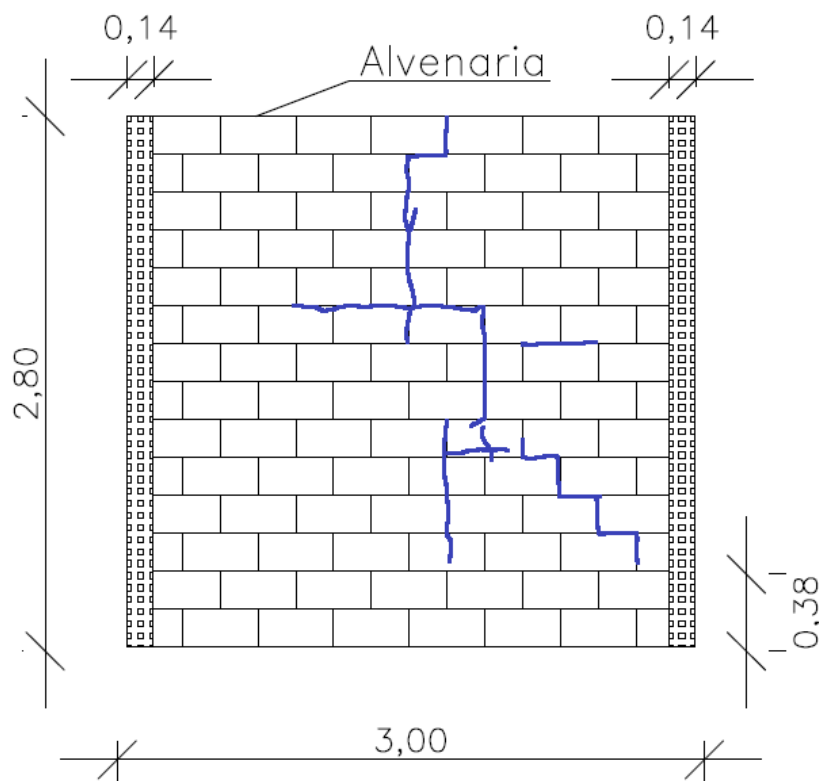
Mapeamento de fissuras da ALV – 1 (Vista frontal)
